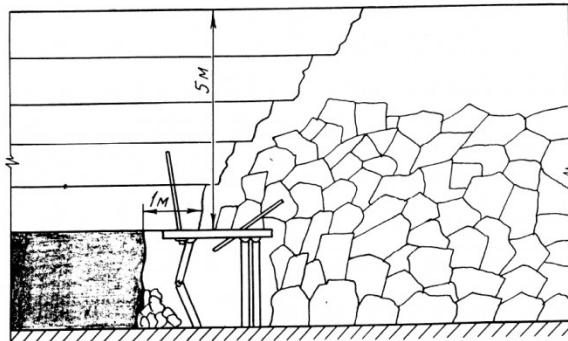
Разрушение пород кровли над сохраняемой выработкой через 10 суток
